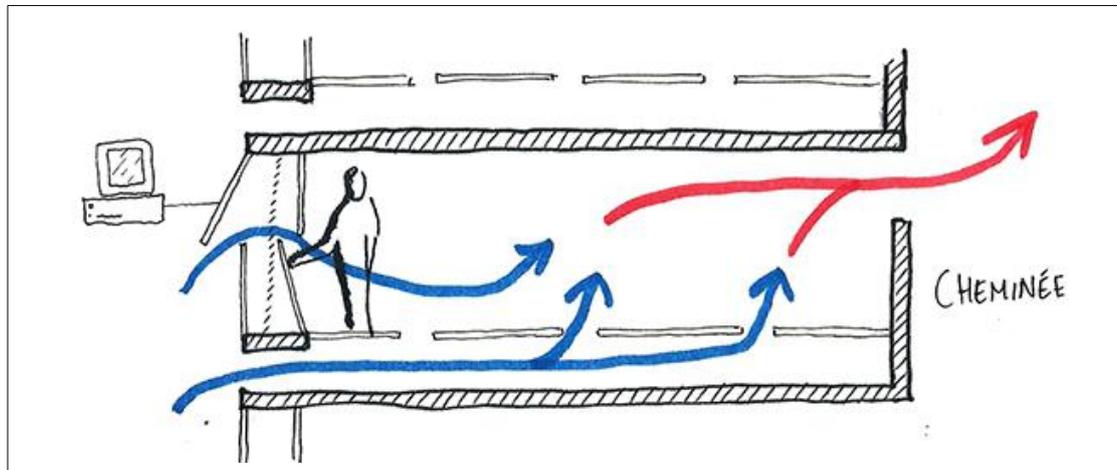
Le régime de la ventilation naturelle par rapport aux doubles façades Est et Ouest.
